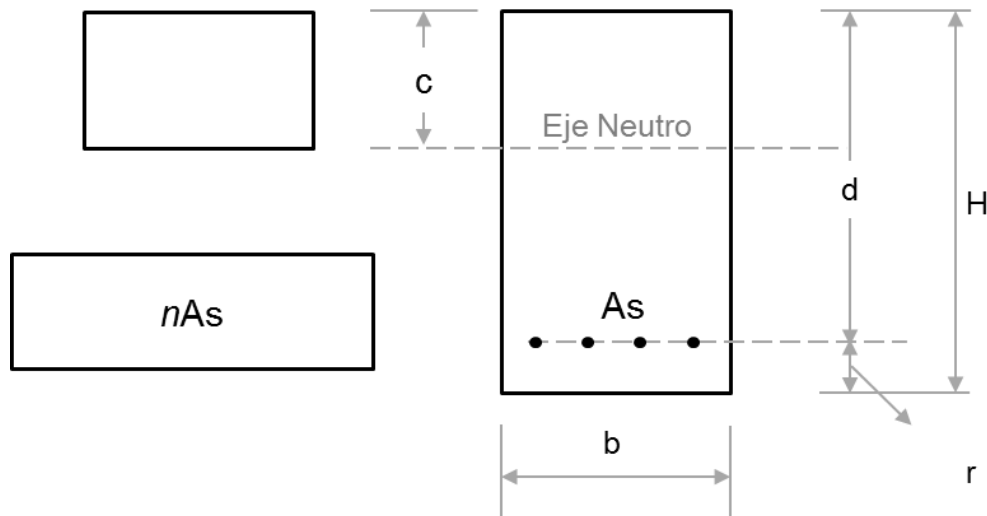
Sección transversal típica de una viga simplemente reforzada. Fuente: Autor
